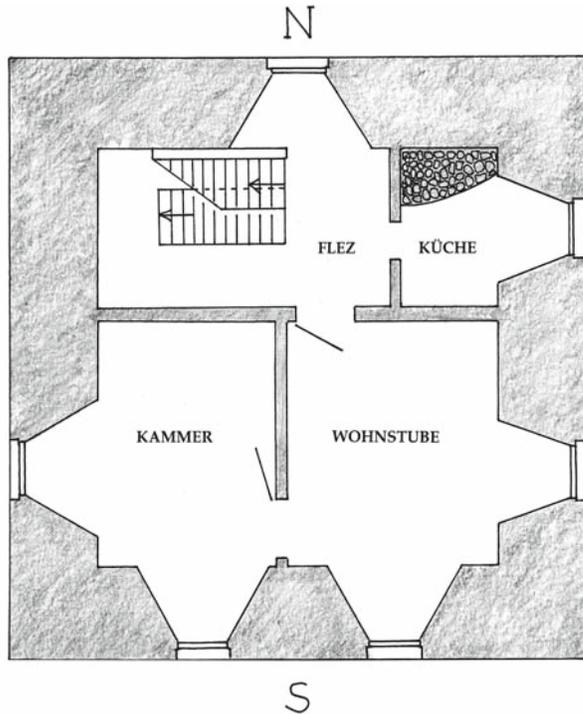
Grundriss der Türmerwohnung, unteres Stockwerk
